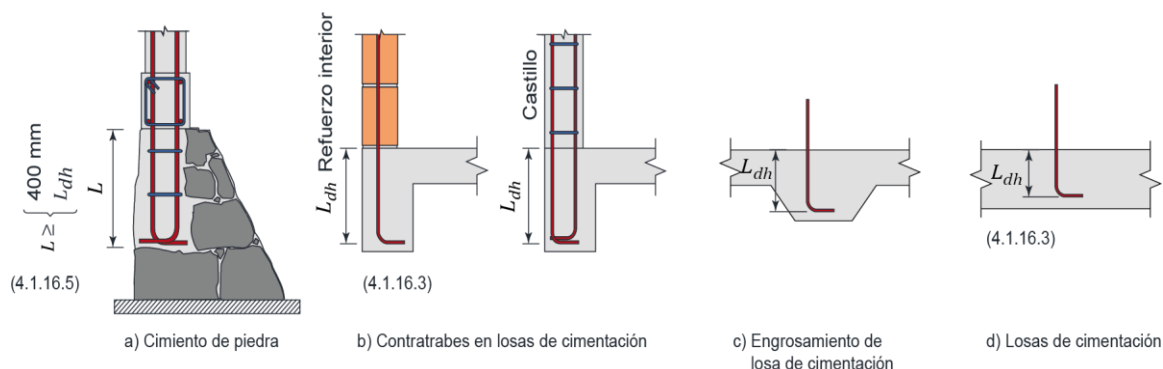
Anclaje del refuerzo vertical en cimientos
